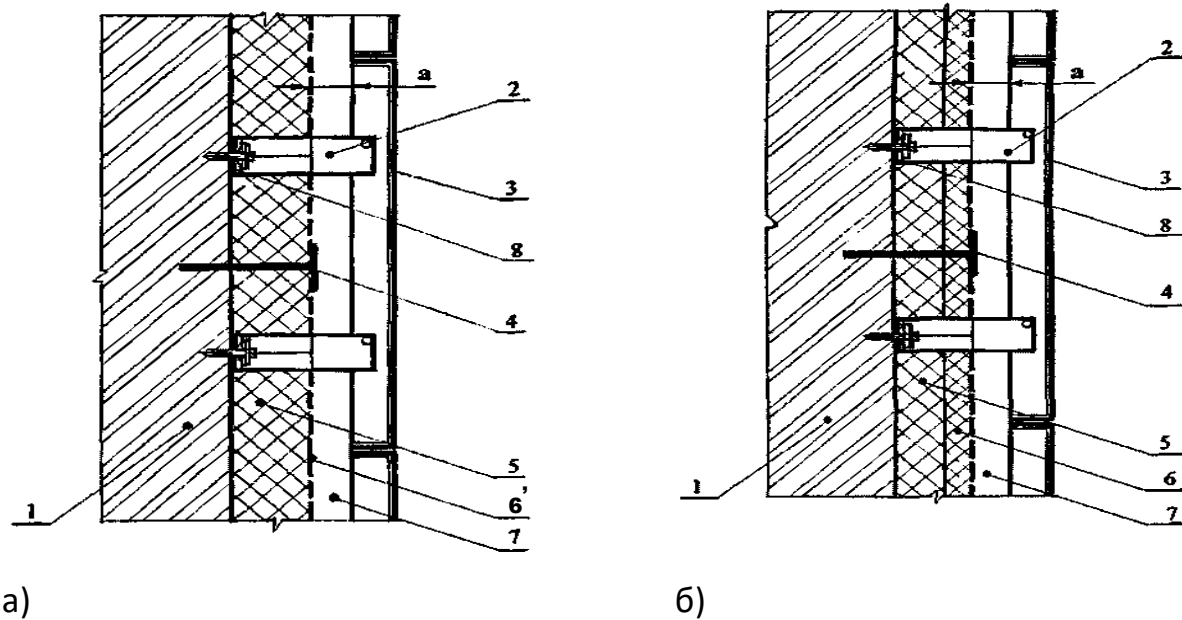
Розрахункова схема вентиляваного фасаду згідно з ДБН
